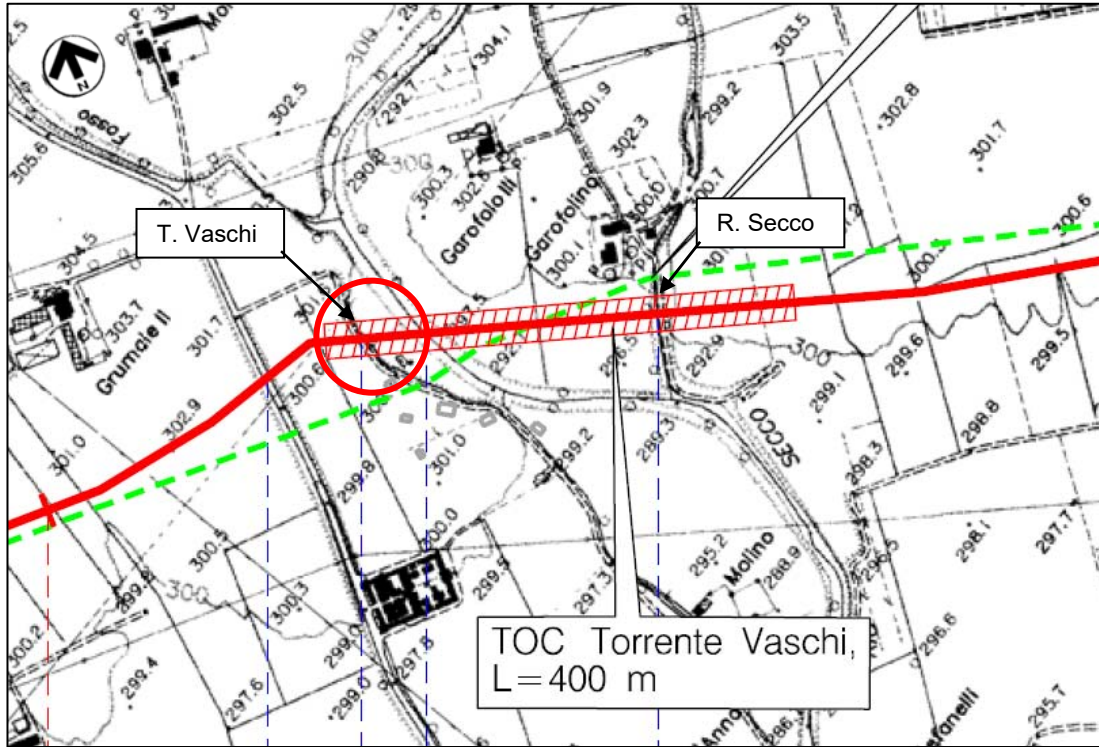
/B – Stralcio CTR con localizzazione dell'attraversamento
